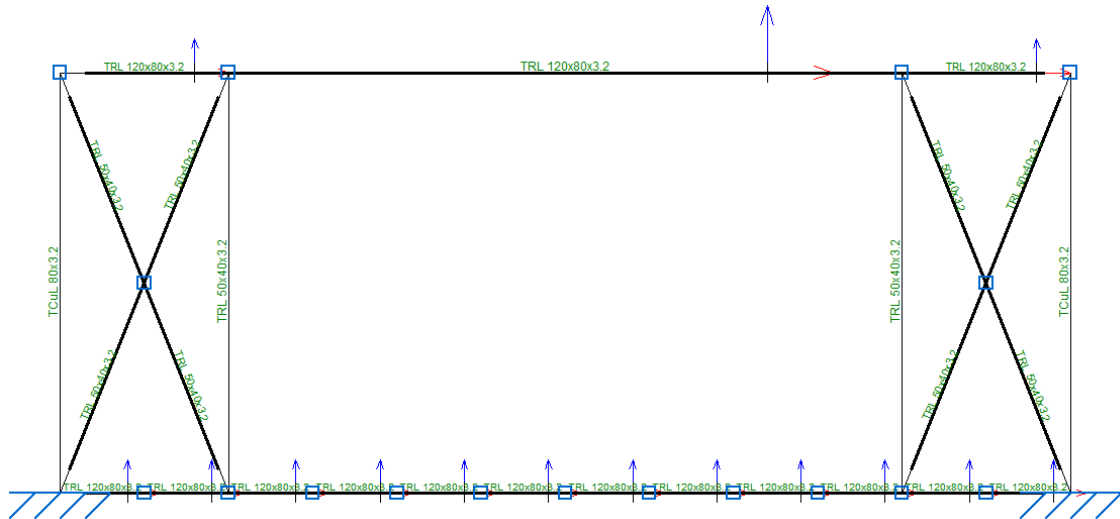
Cruces de San Andrés en Fachada Frontal y Posterior
